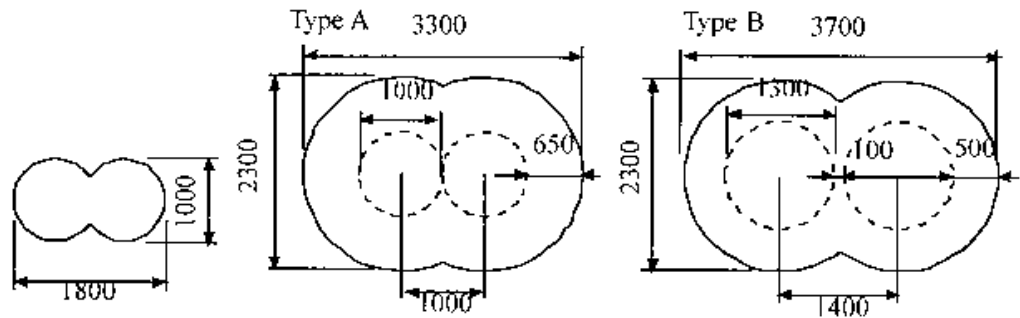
/7: Colliding jetting voor de uitvoering van vierkante gROUTkolommen.
